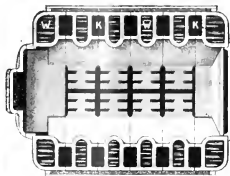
Coupe horizontale d'une chaudière et disposition de la grille.
